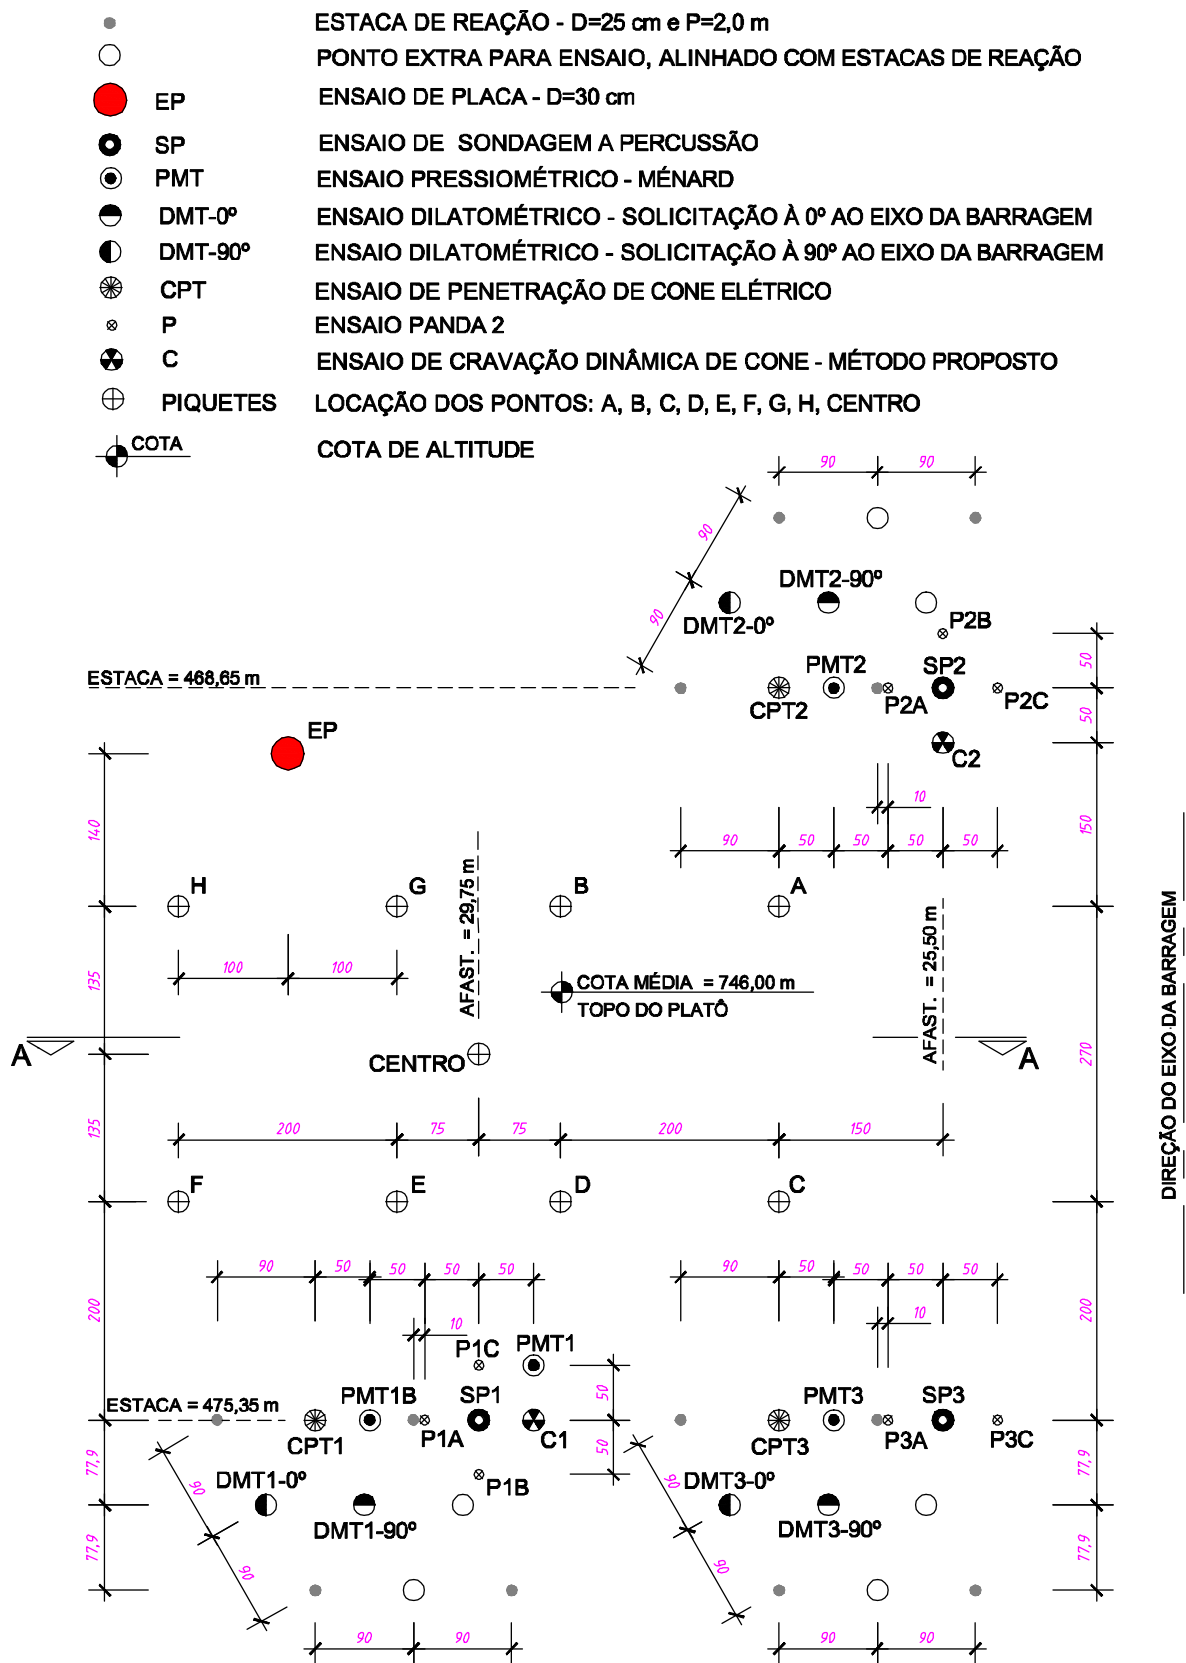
Planta de localização dos furos de sondagem dos ensaios de campo.
